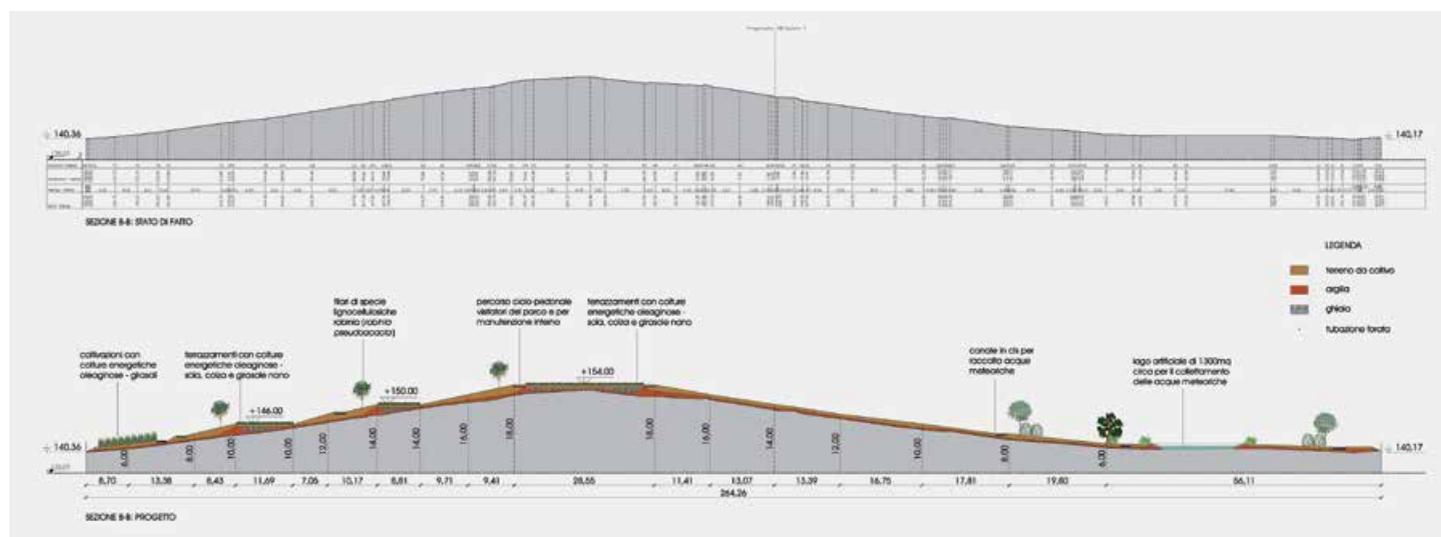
Profilo di progetto del terreno. Sezione trasversale della discarica
